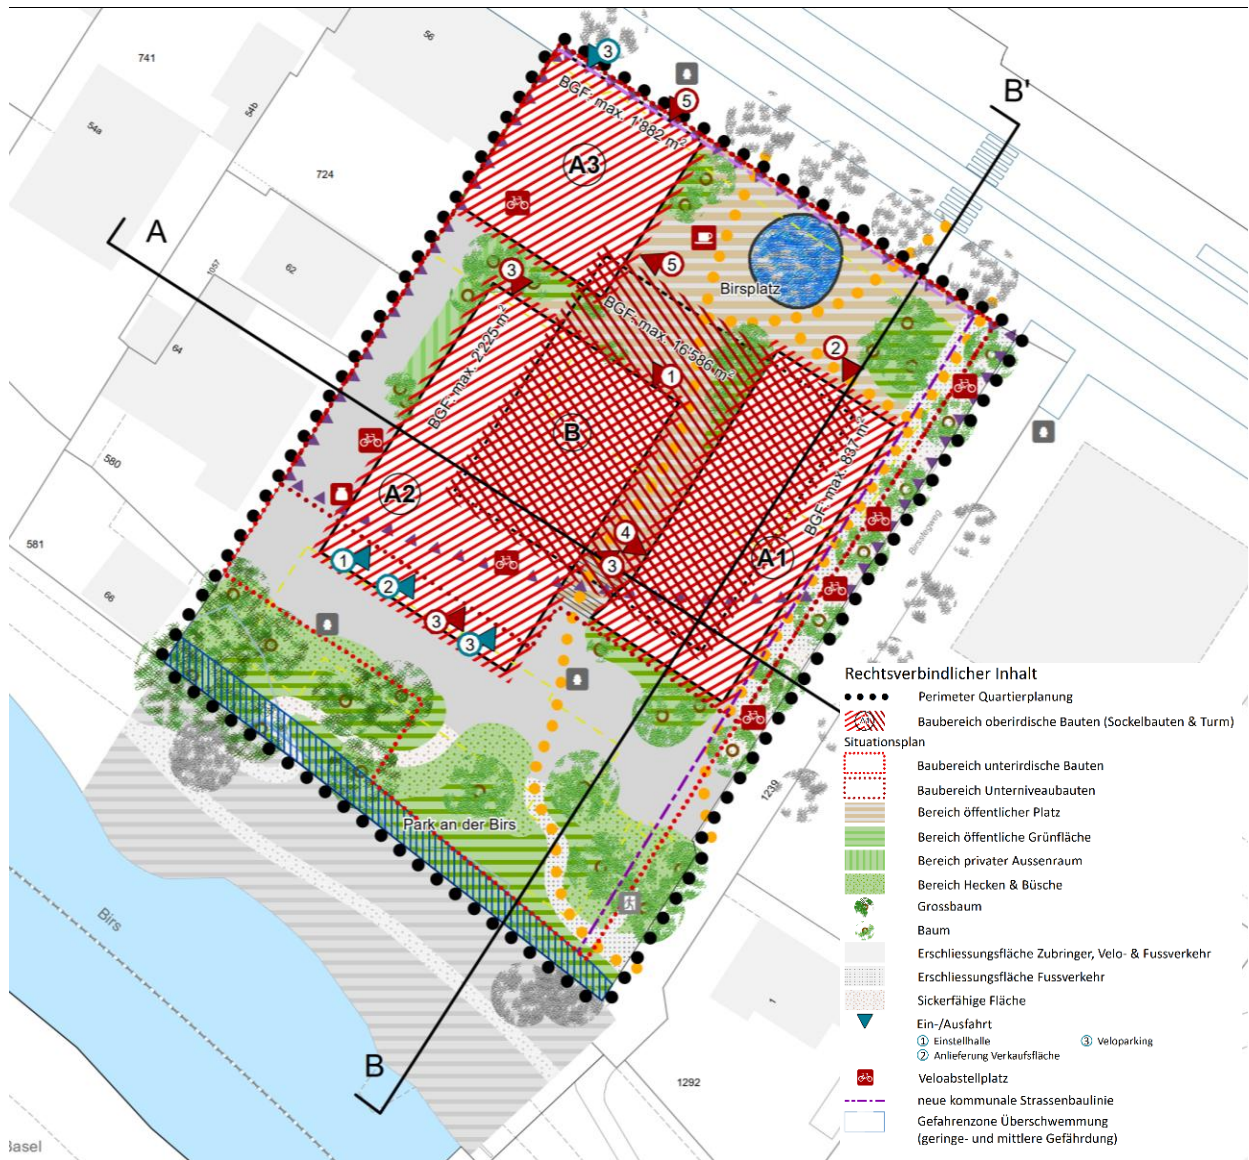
Perimeter Quartierplanung mit Zonenplan Siedlung (Geoportal.ch 2025)
